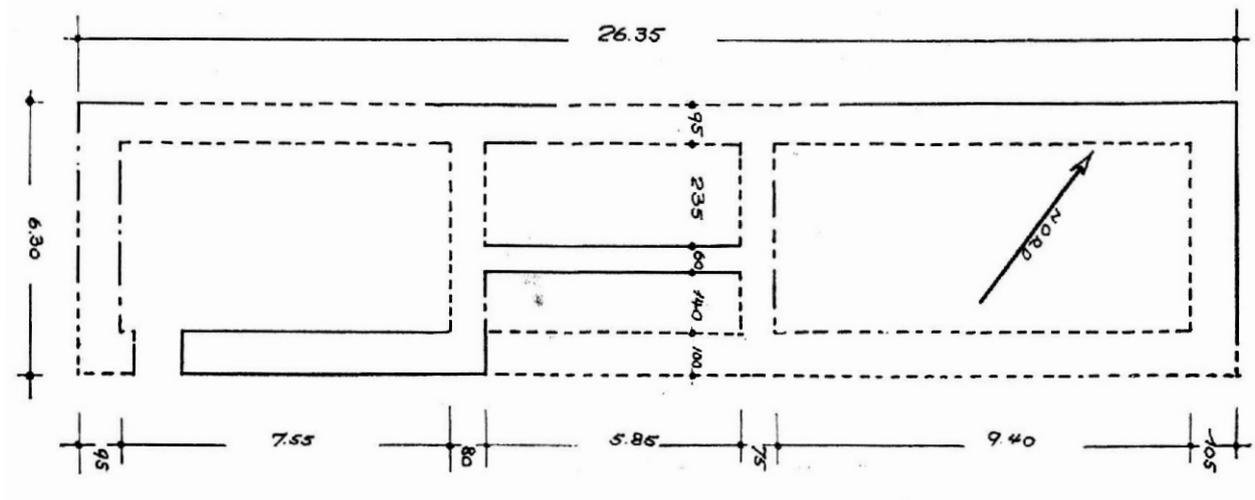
Festung an Route Dreros - Olous, am Hang des Oxa, schematischer Grundriss
